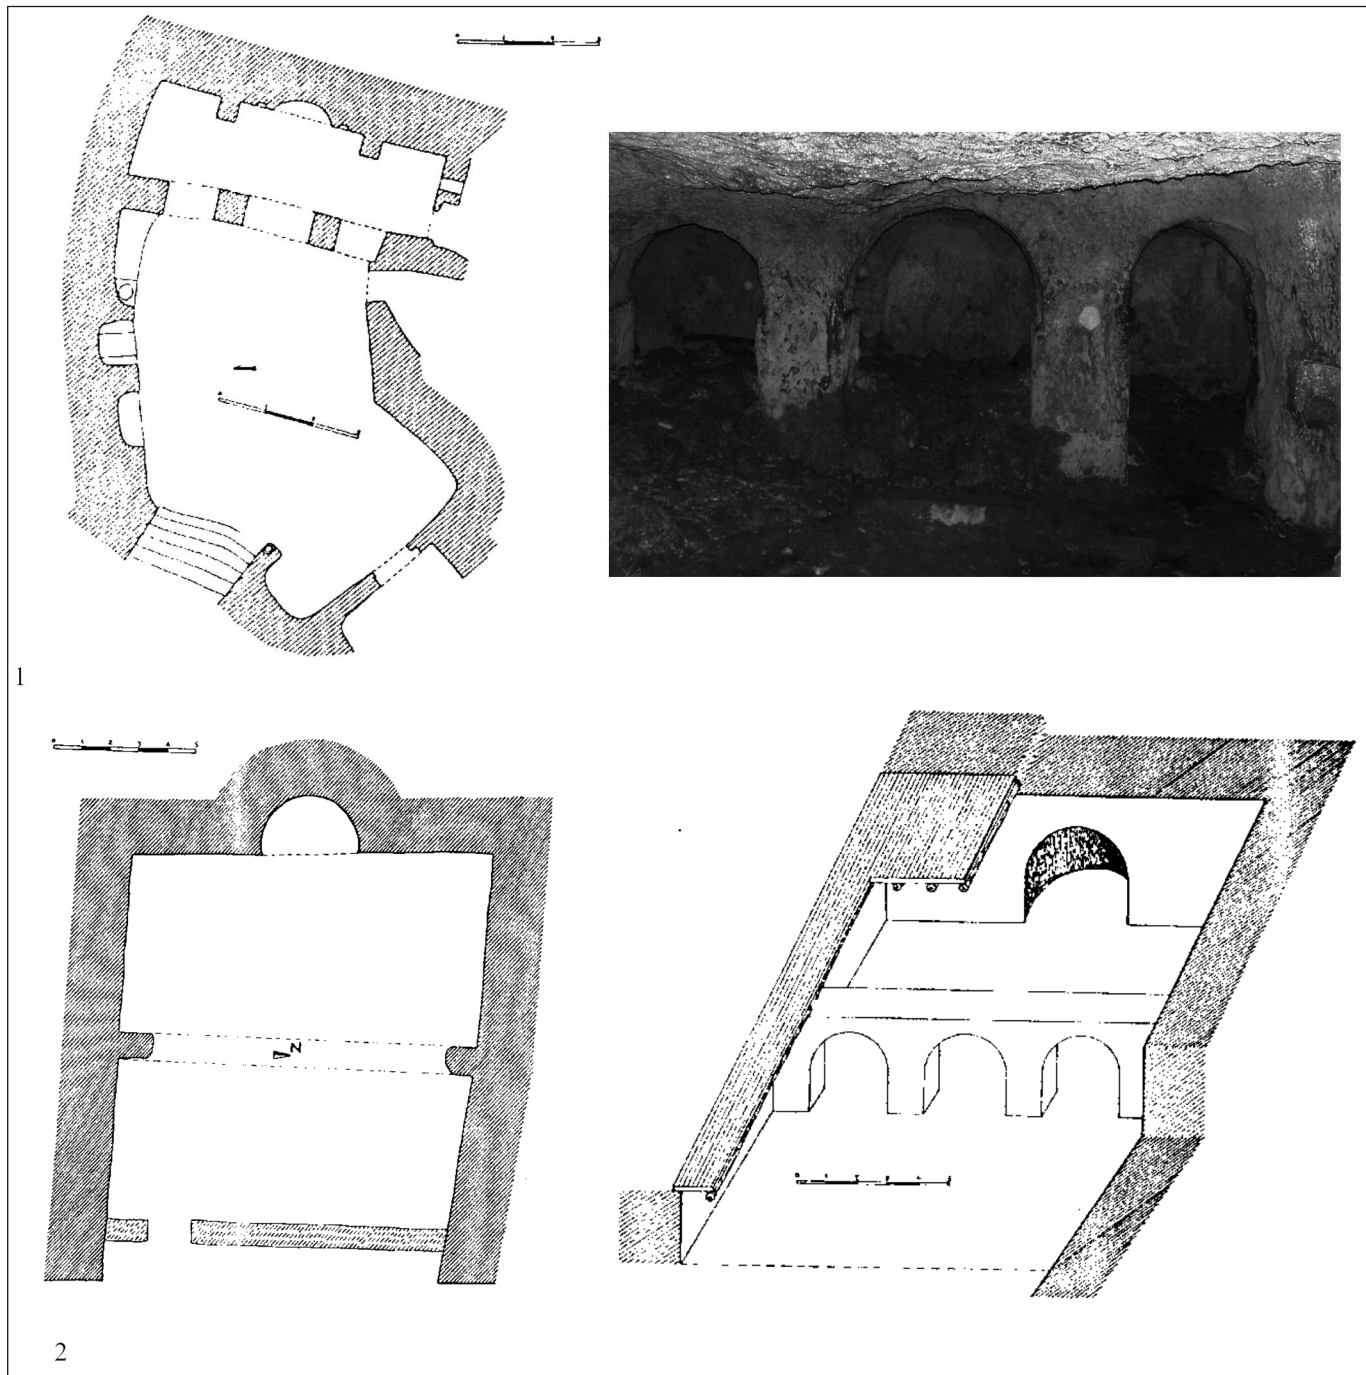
/ 1. Noto, Santa Lucia di Mendola, chiesa inferiore, pianta (da GIGLIO 2002) e triforio. 2. Canicattini Bagni, Santa Maria del casale Alfano, pianta e ricostruzione assonometrica (da GIGLIO 2002).
